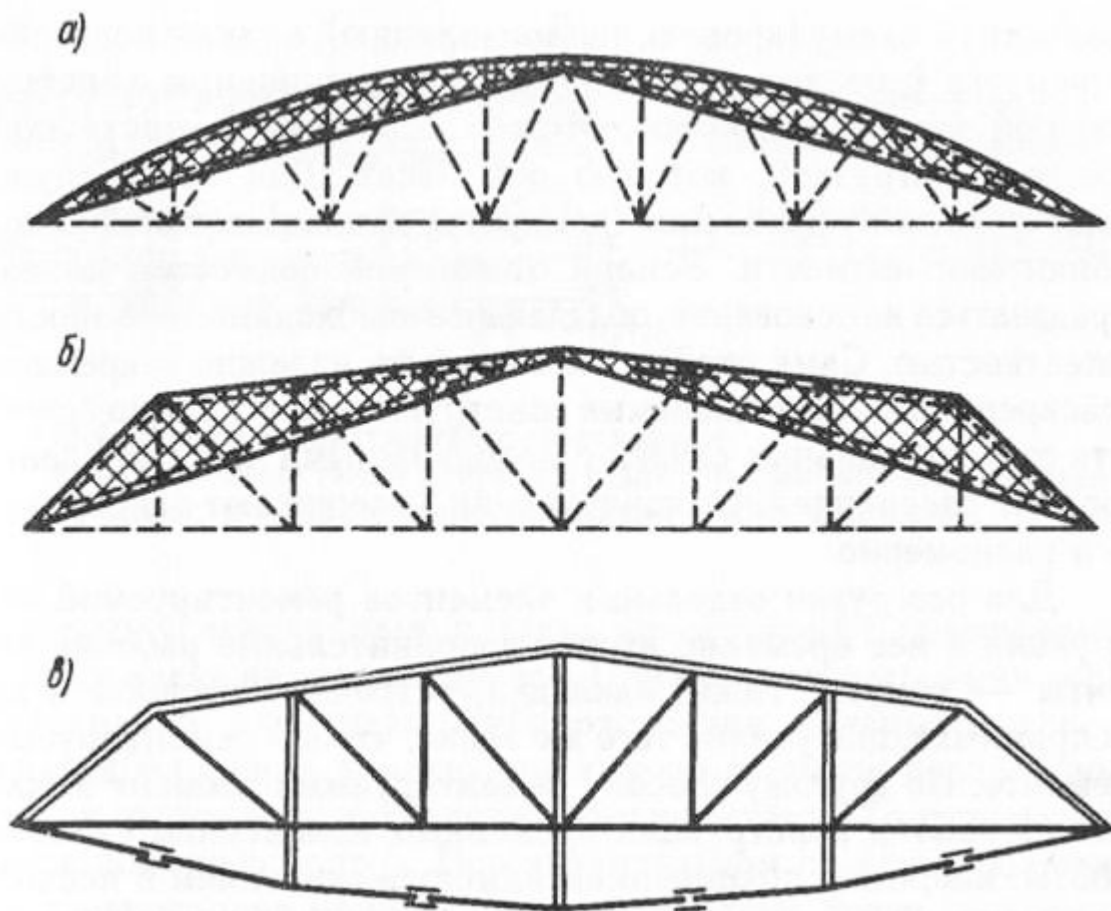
Усиление ферм: а, б — устройство дополнительных поясов с перекрестной стенкой; в — устройство шпренгеля
